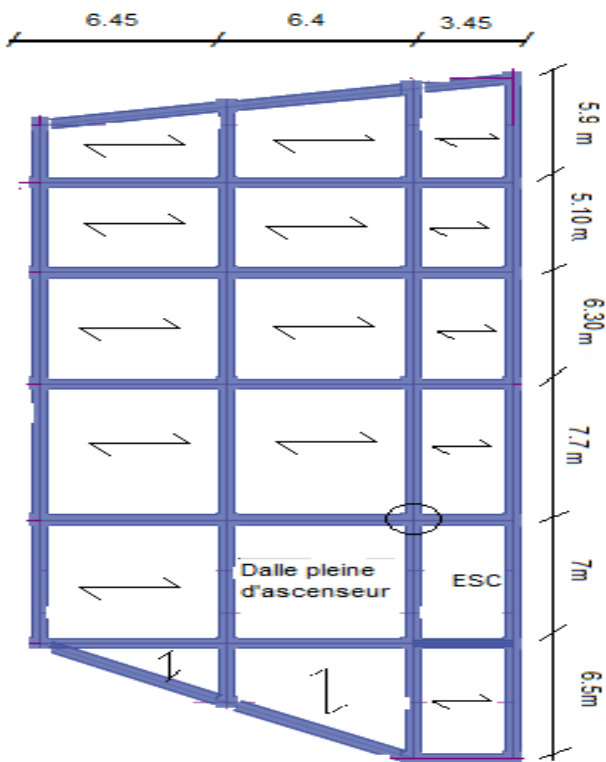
Plan de disposition des poutrelles (sous-sol et E.sol)
